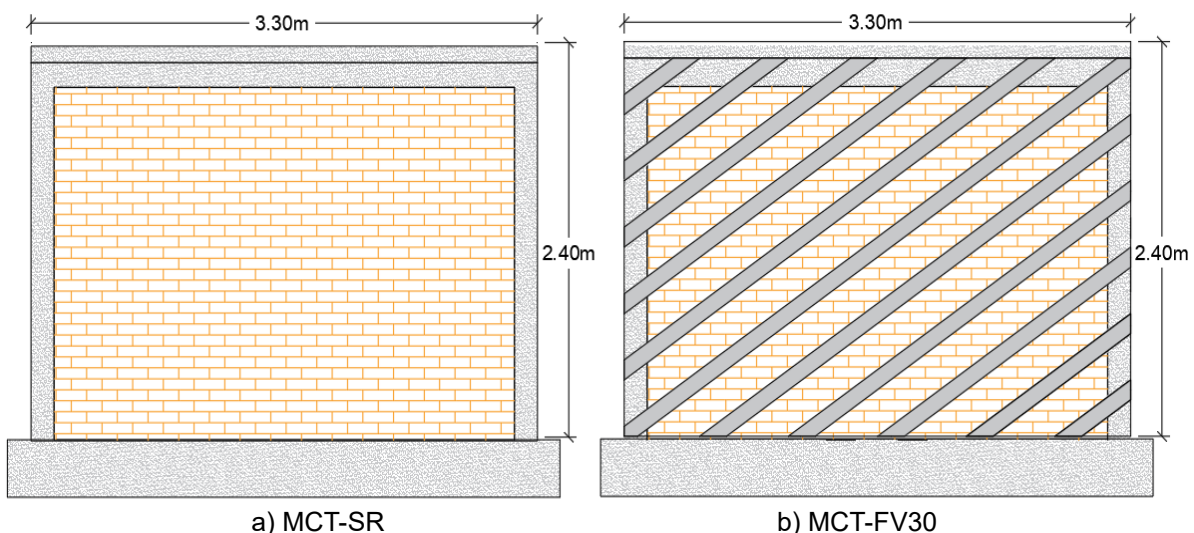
Configuración de los especímenes. a) muro sin refuerzo, b) muro con GFRP
